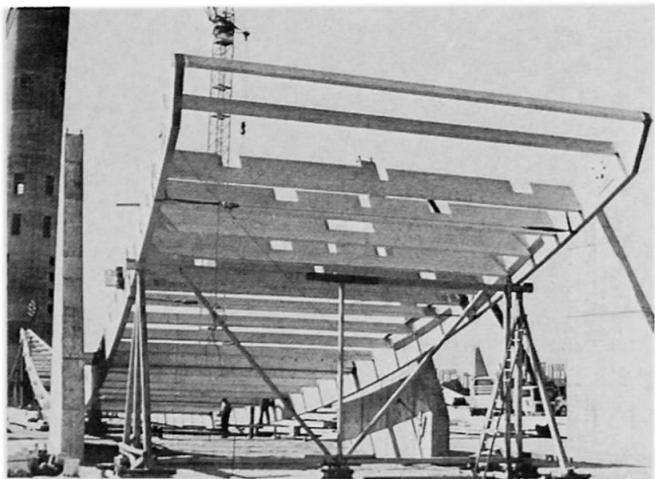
Die fertigmontierten Dachsegmente, einschliesslich der Sparren und der vernagelten Bohlenlage, werden durch 3 Kräne eingehoben
